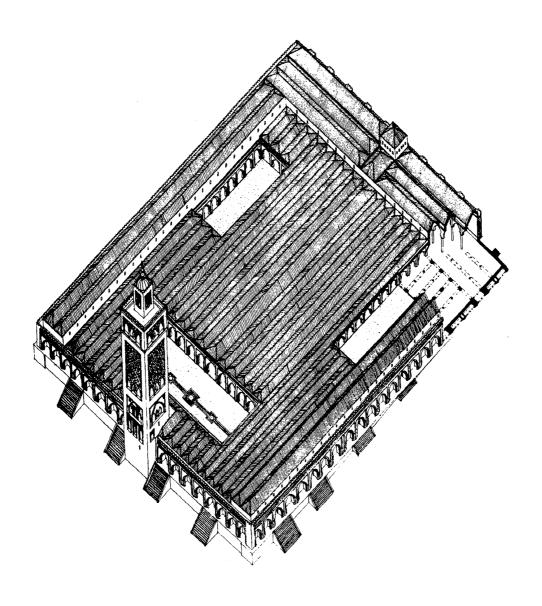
مسقط أفقي لجامع تلمسان بالجزائر. (عن: تيراس).
